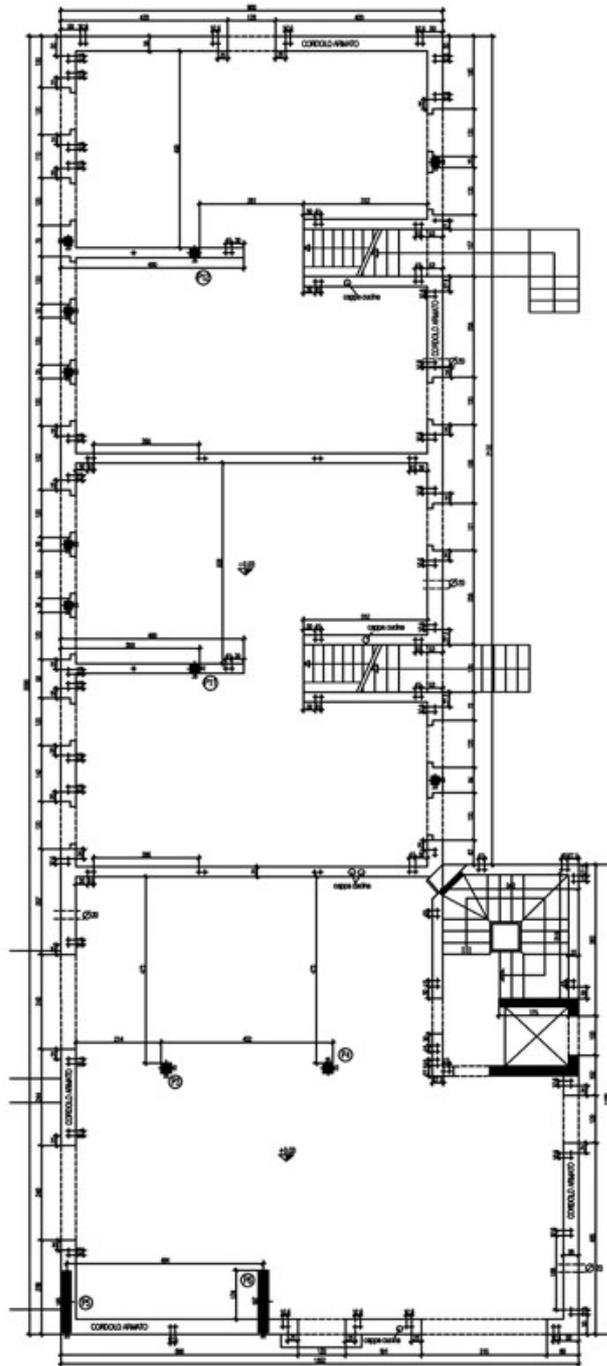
Pianta della struttura in muratura armata del piano tipo del fabbricato oggetto di ricostruzione.
